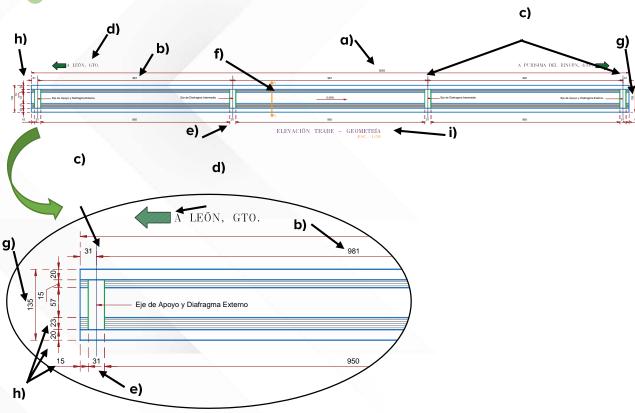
Ejemplo geometría en elevación de la trabe (elemento 3)
